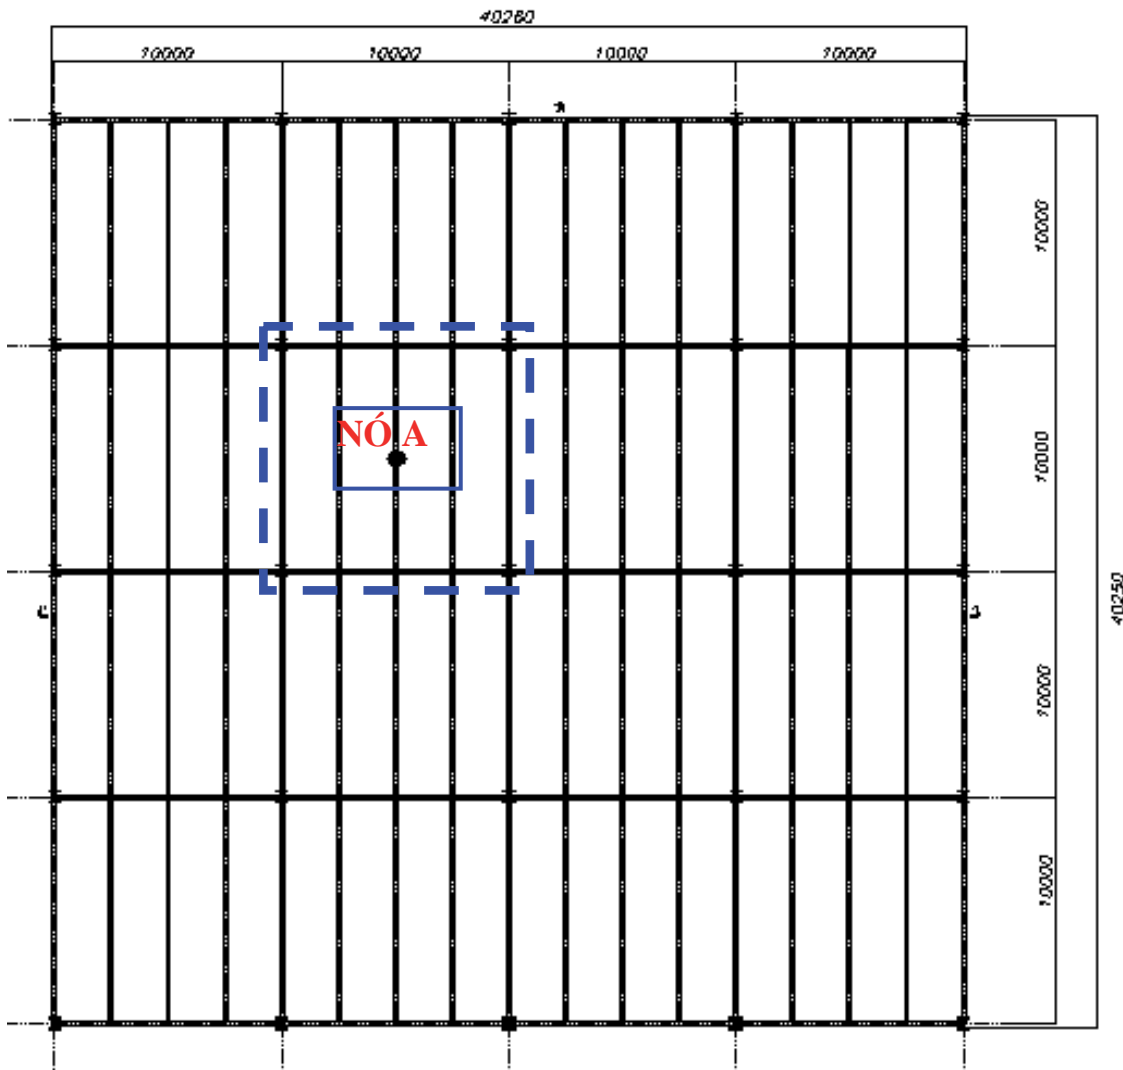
Planta baixa do piso misto (aço-concreto) investigado.
